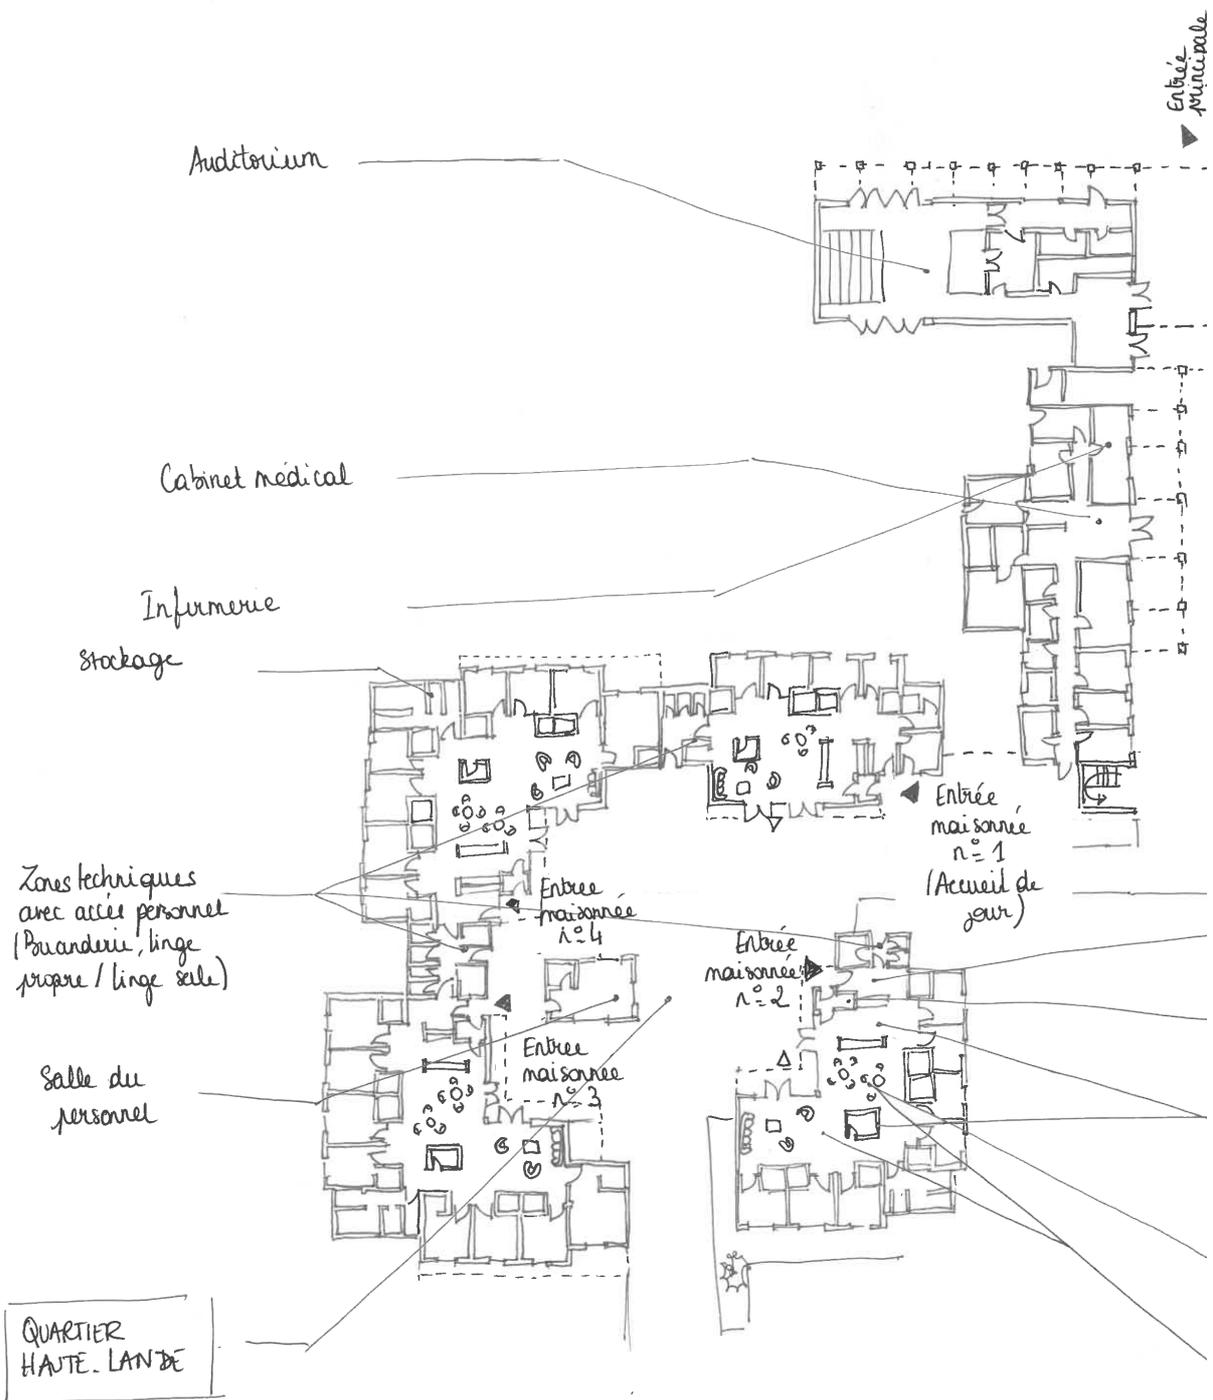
Village Alzheimer France - Plan masse de l'établissement
